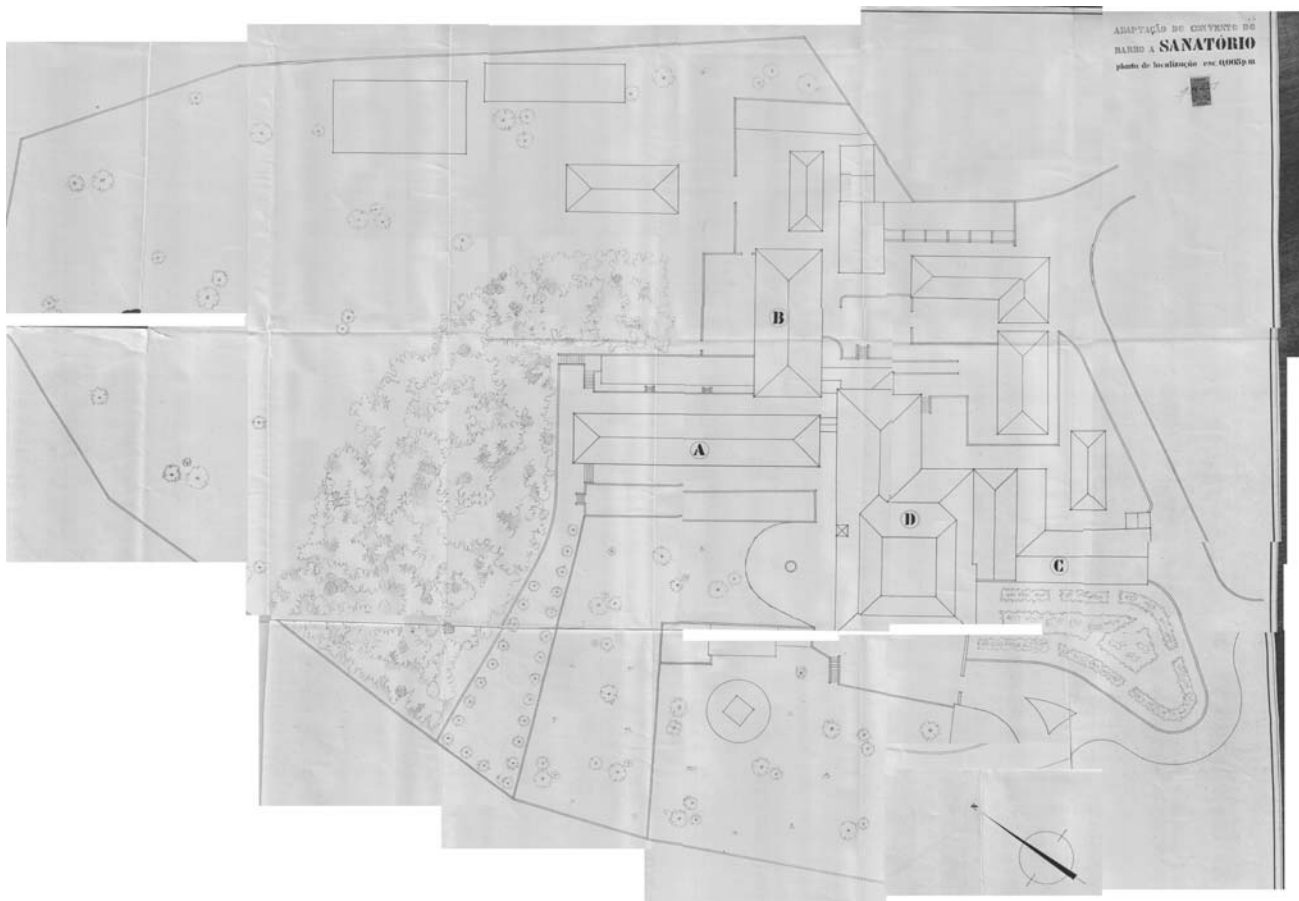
Adaptação do Convento do Barro a Sanatório. Planta de localização (ABCD). DGCH, s/r.
